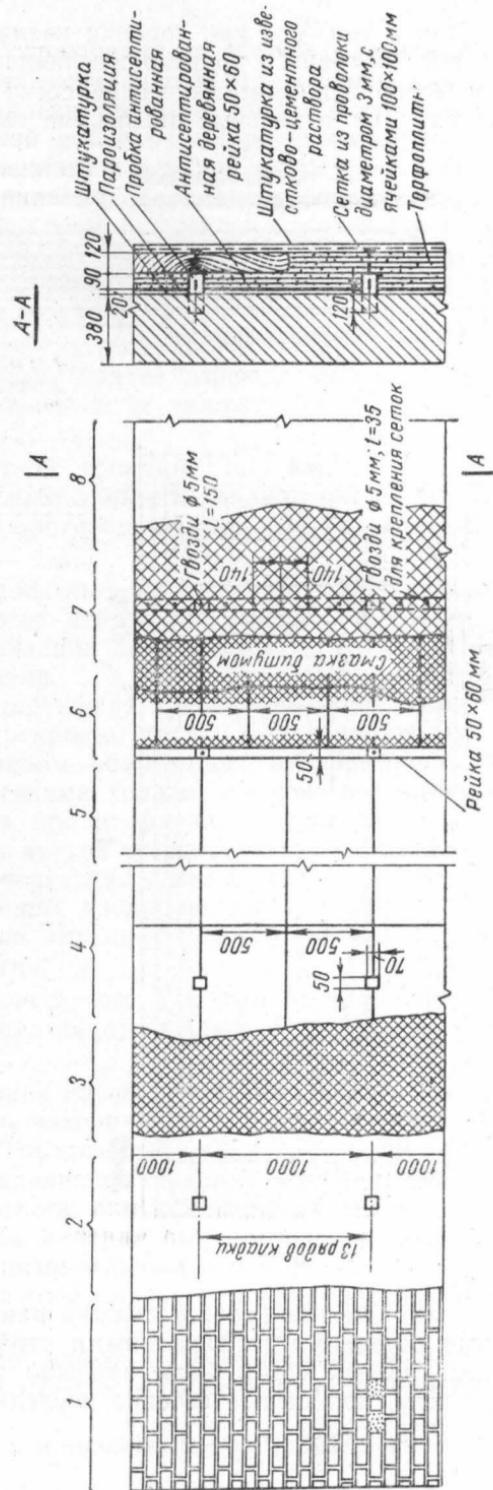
Теплоизоляция кирпичных стен торфоплитами:
